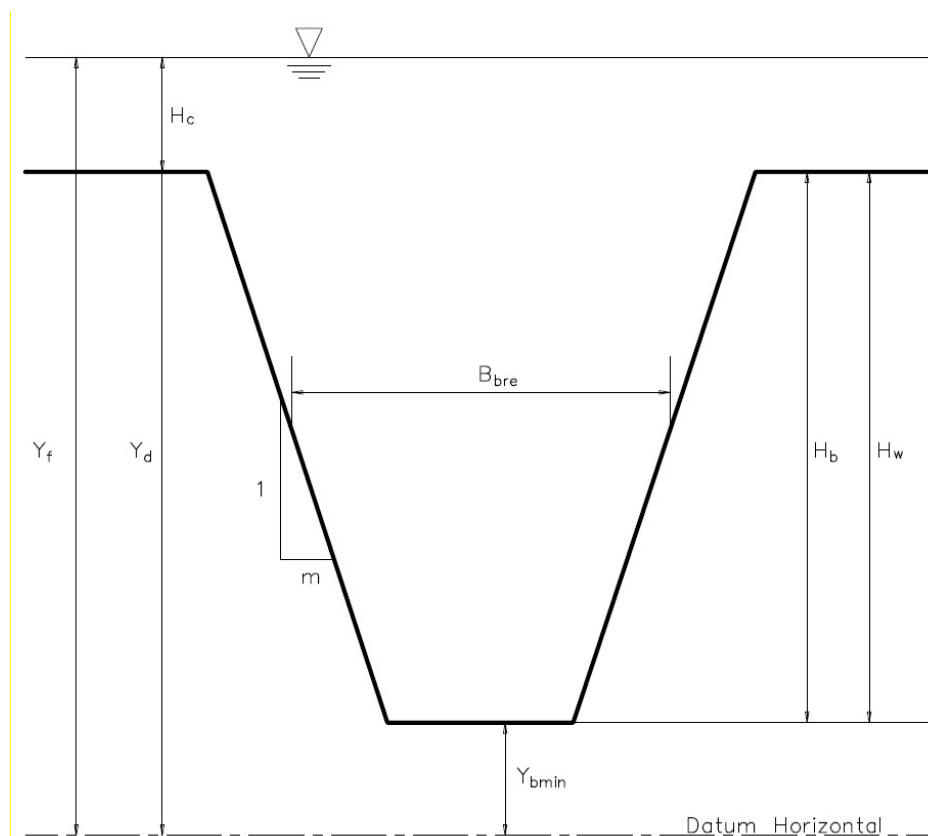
Geometria final de brecha em barragens de terra. (adaptado de Froehlich, 2016).
